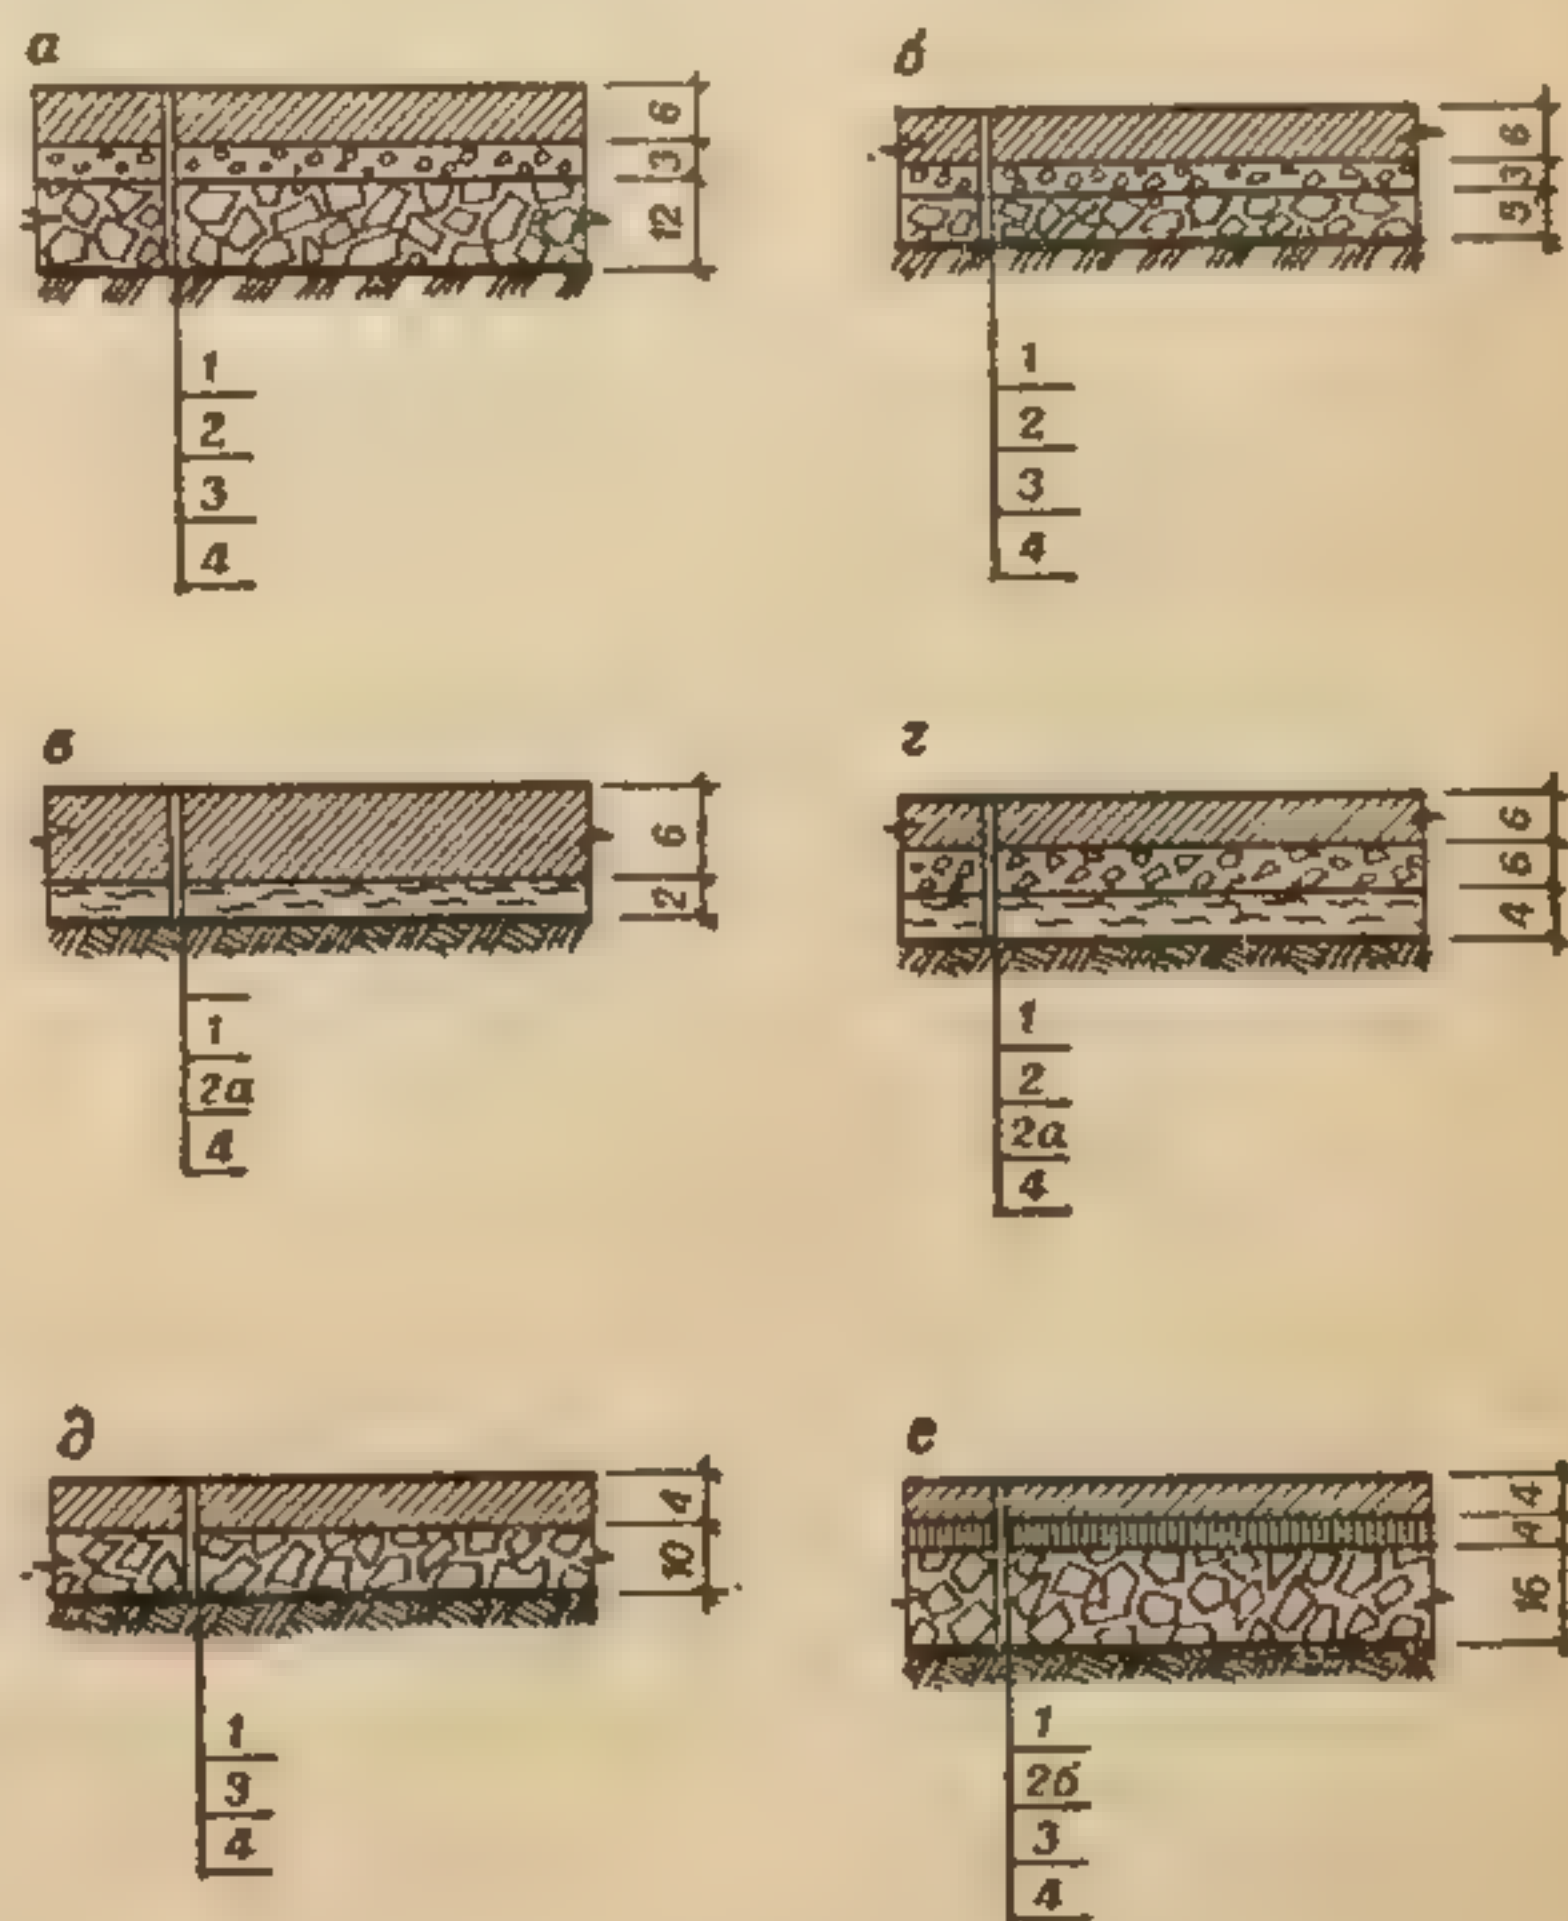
Конструкции спортивных площадок со специальными покрытиями:
